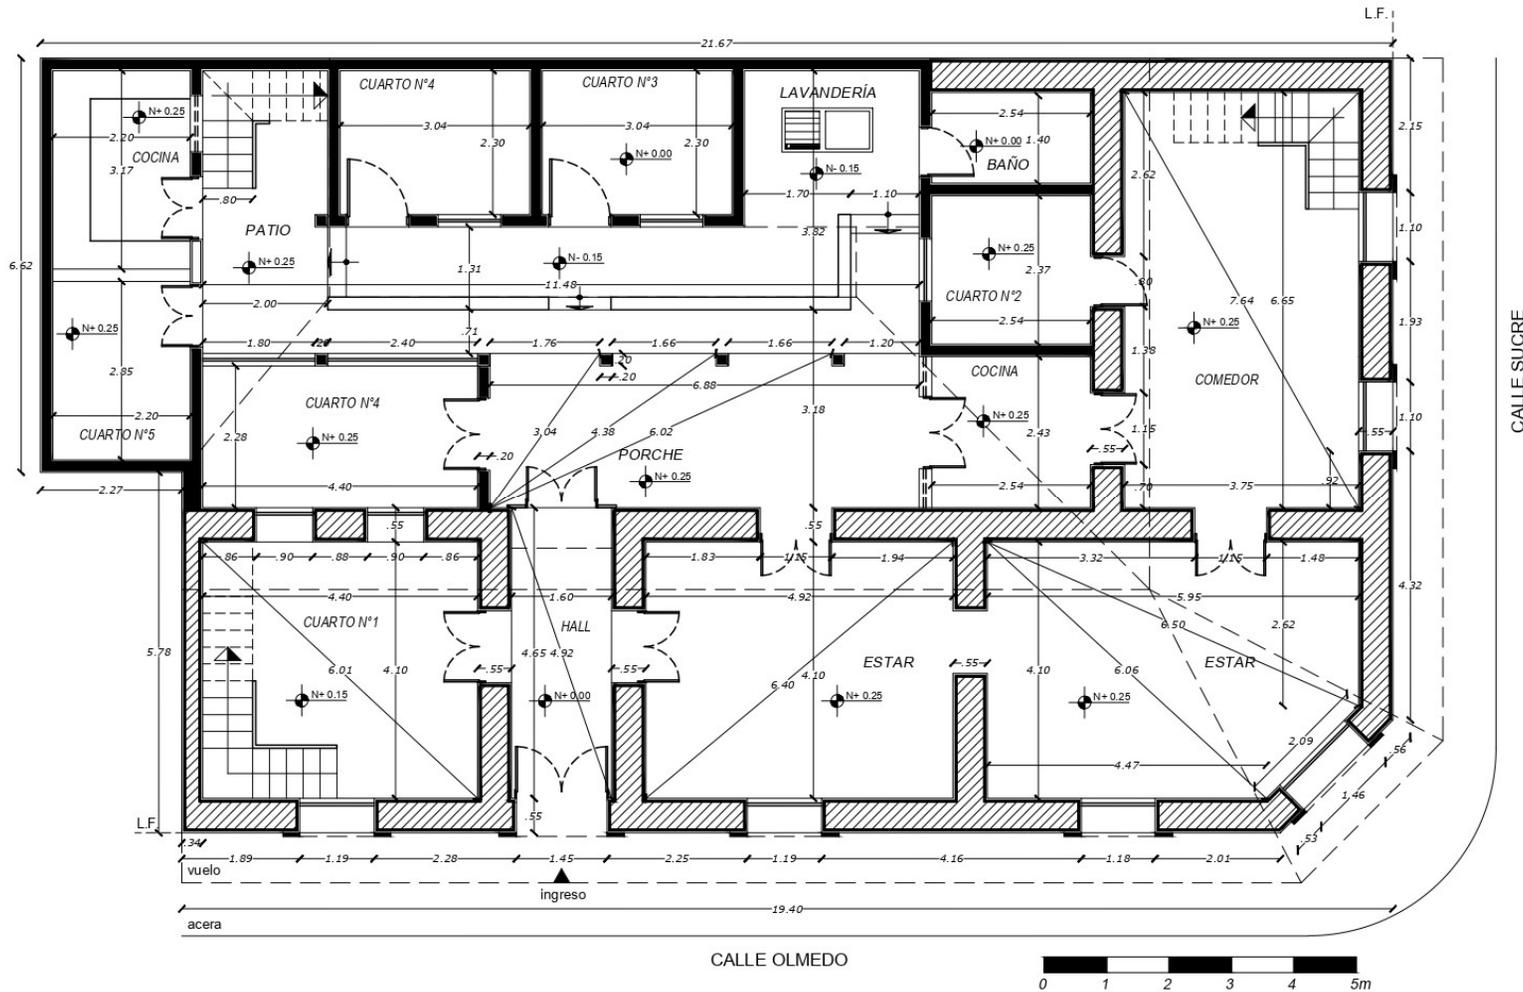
Planta Baja Inmueble Histórico. Fuente: Elaboración propia
